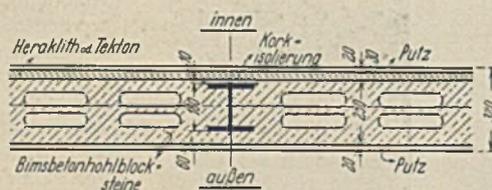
Wandausbildung des Stahlskelettbauwerks Becker, Köln.
